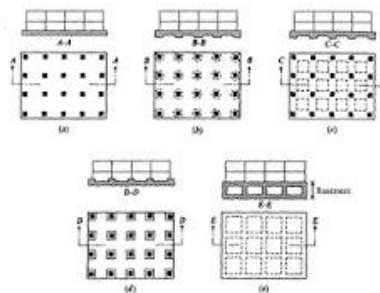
19 Pondasi Telapak (Sumber : Thoengsal, 2016)
